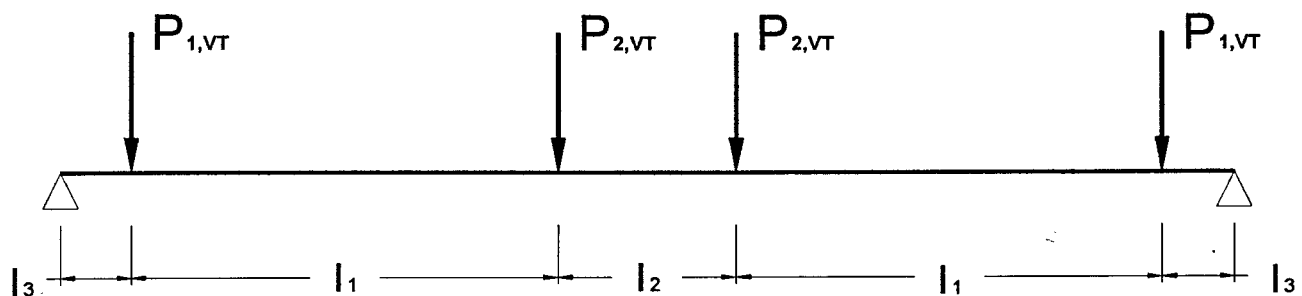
ESQUEMA ESTRUTURAL DA VIGA TRANSVERSAL
